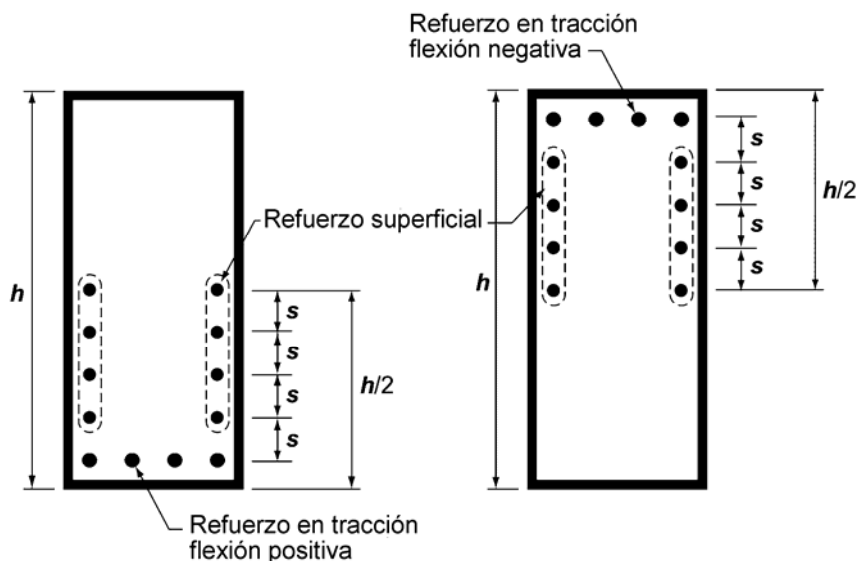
Refuerzo superficial para vigas y viguetas con  $h > 900$  mm
